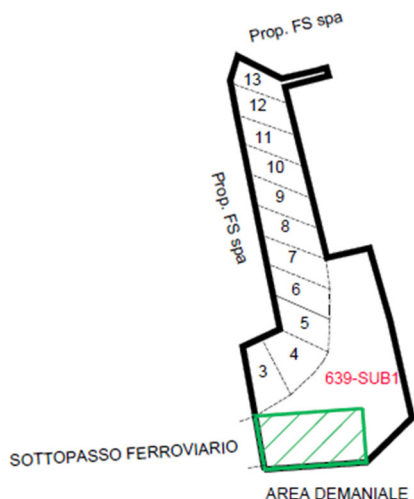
Parcellare 8 - Stralcio dell'elaborato planimetrico con evidenziata la zona di passaggio del camion
